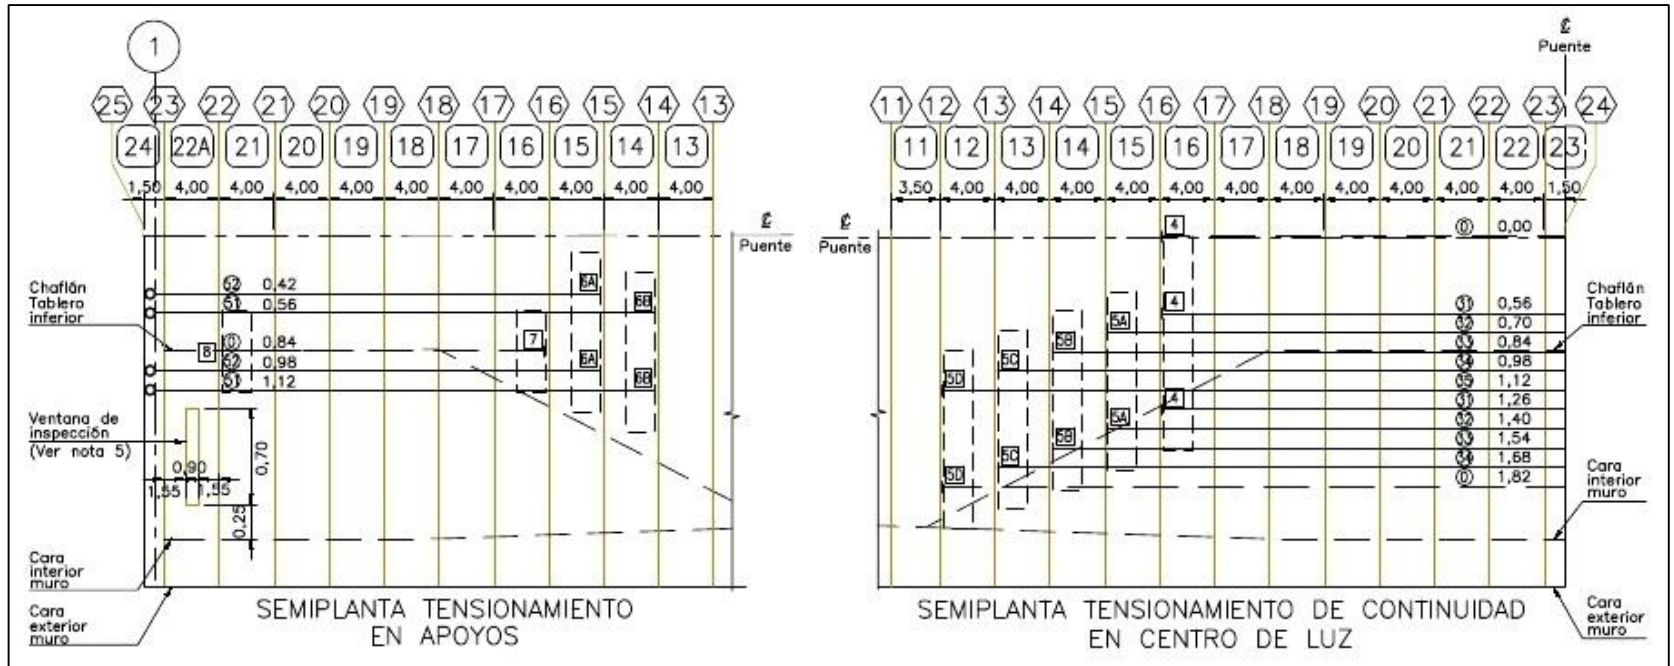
Trayectoria de los cables en Semiplanta Inferior en el Apoyo 1 del Eje 1 y centro de luz en los Voladizos 2 y 3.
